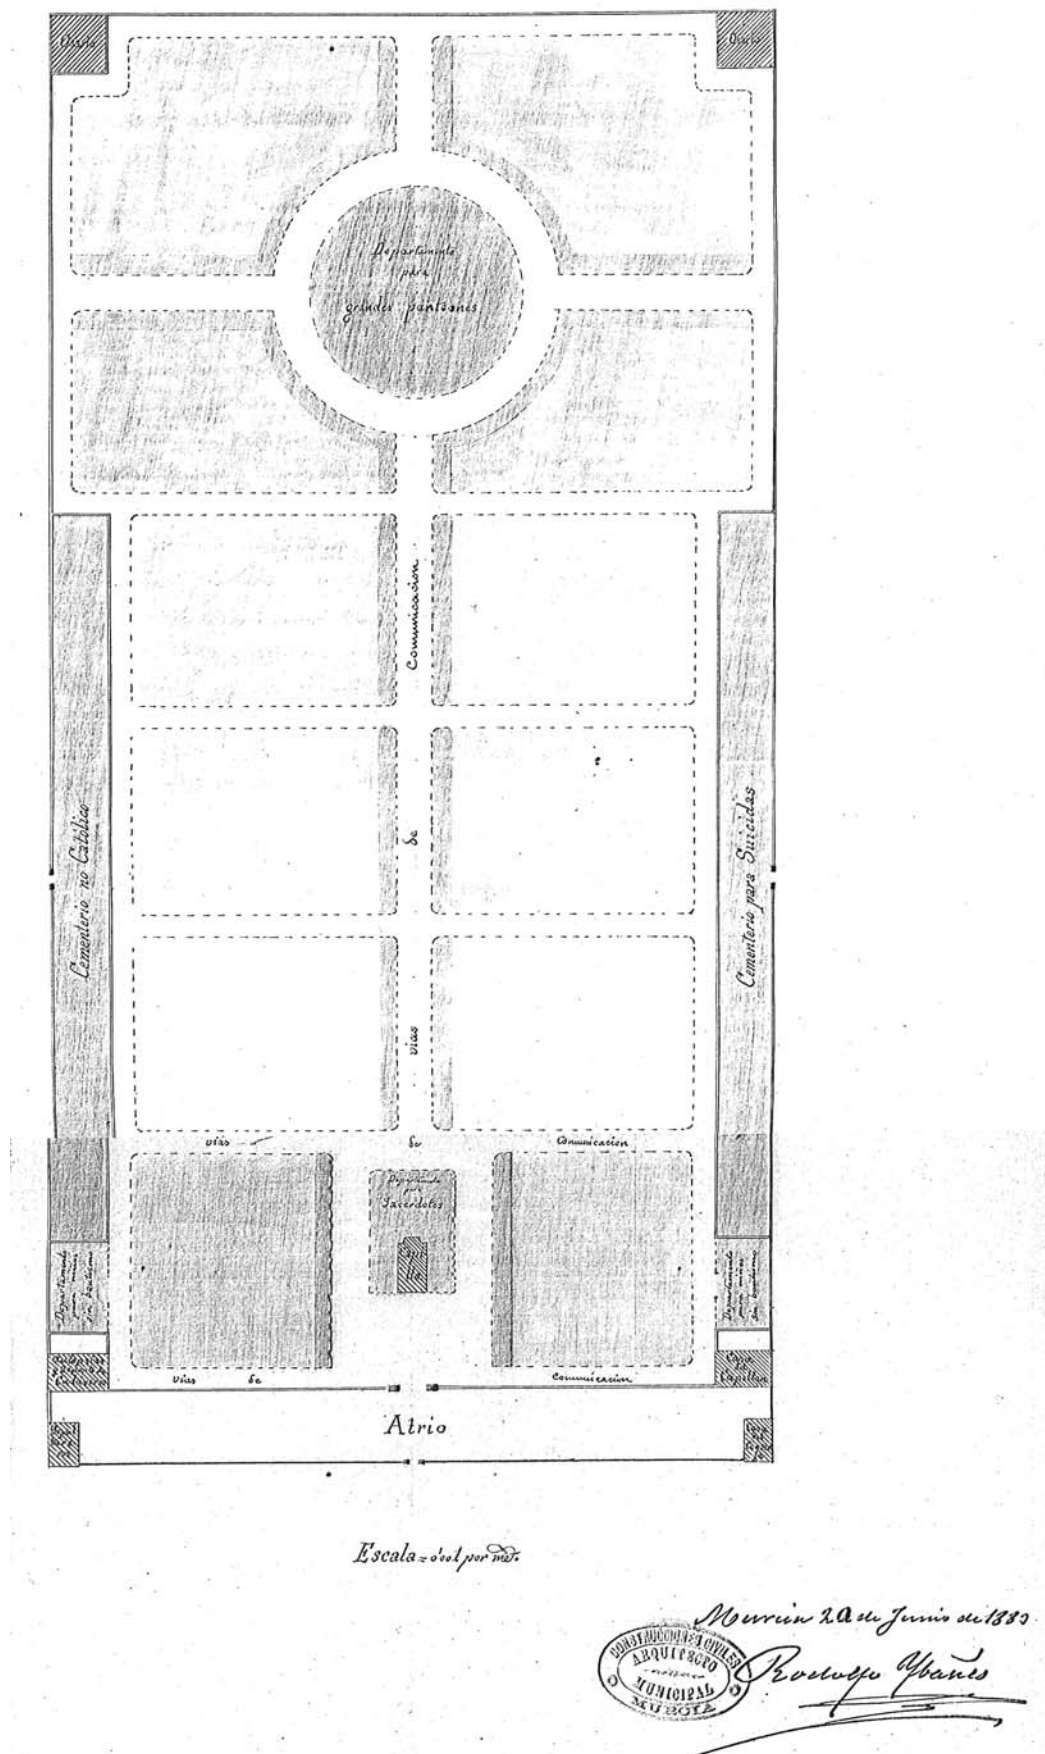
Plano del cementerio. Rodolfo Ibáñez. Primer proyecto. 1883
